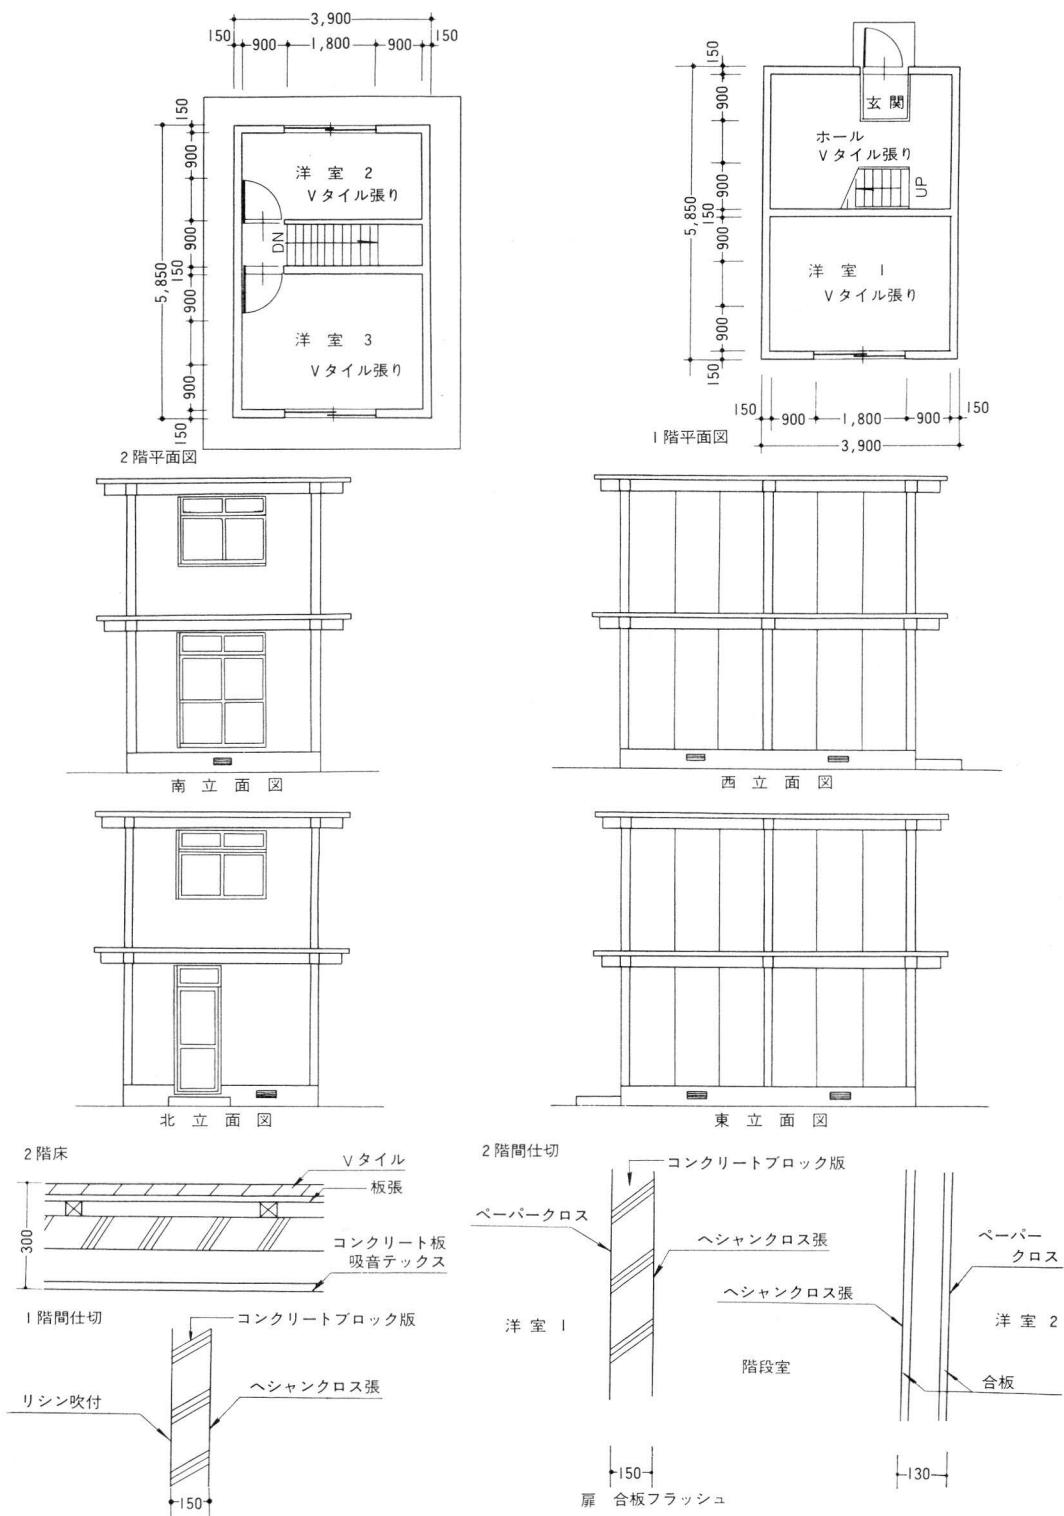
BH 1、BH 2 平面図、立面図、間仕切構造図
